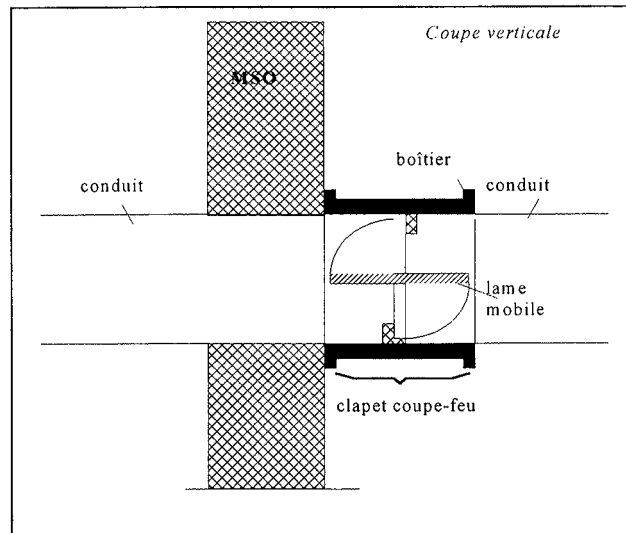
Mise en place de clapet coupe-feu dans les conduits traversant un MSO
